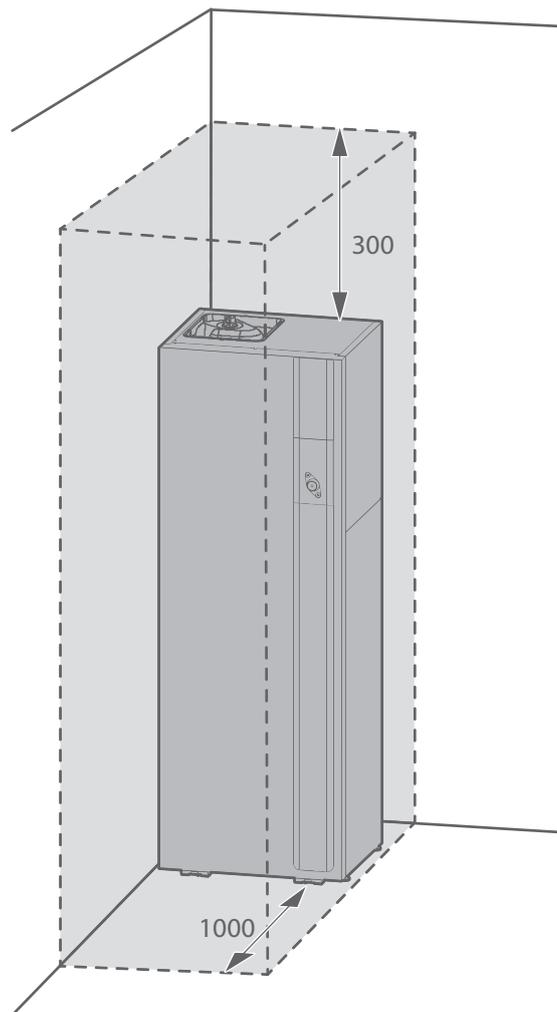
Dégagements minimum d'installation autour du module hydraulique pour l'entretien
